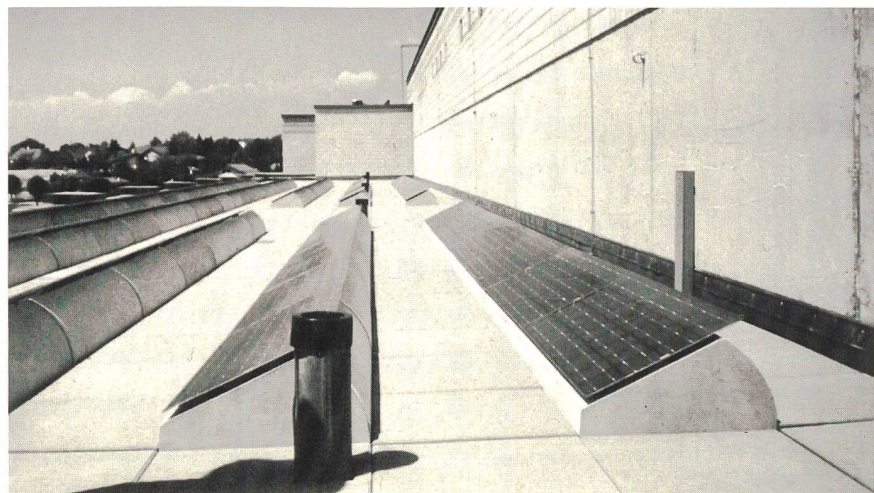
Solare Pilotanlage mit Betonsockeln als Tragkonstruktion (Solarmodule auf dem Dach der ETH Lausanne VD). (Fotos: EPFL/PMS/Enecolo AG)
